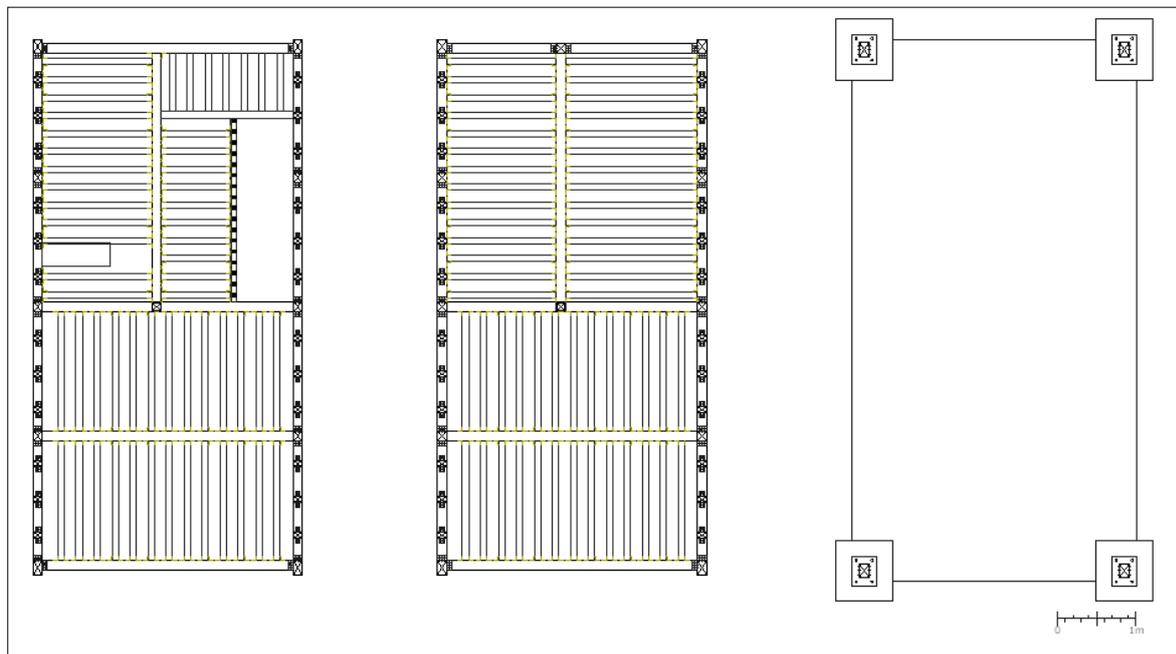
Planta estruturais da habitação base (tipologia 1). Esquerda (cota +3.20), centro (piso térreo) e direita (fundações)
